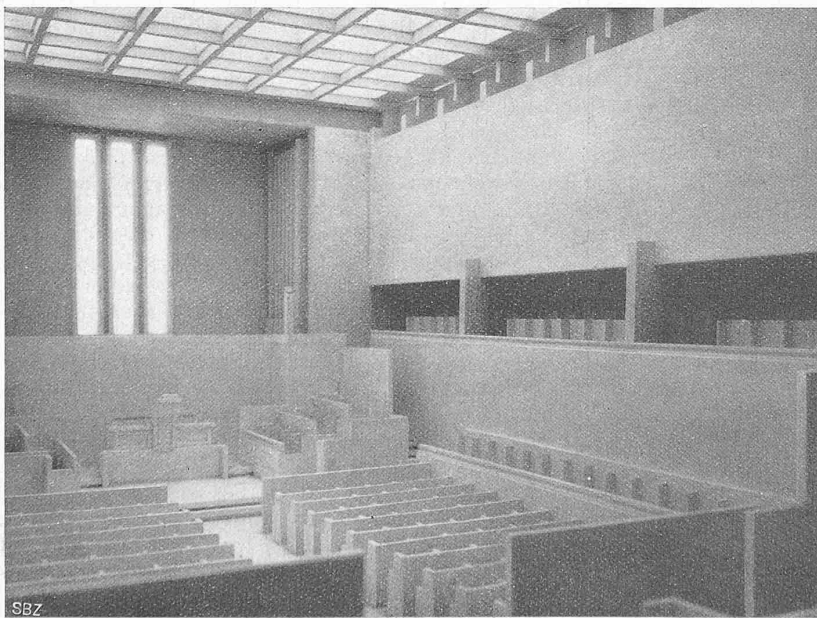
Modellansicht und Abb. 9 Obergeschoss-Grundriss 1:1500 (Entwurf 1921).
